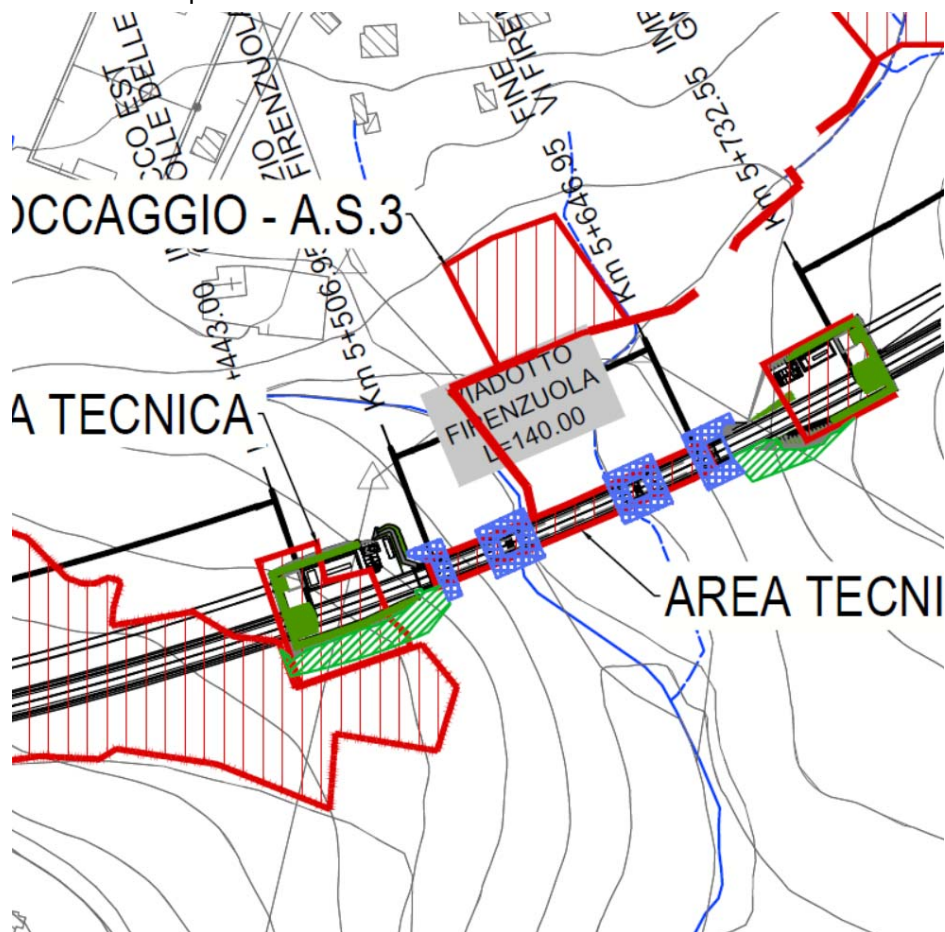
Stralcio planimetrico mitigazione spalle e pile Viadotto Firenzuola
